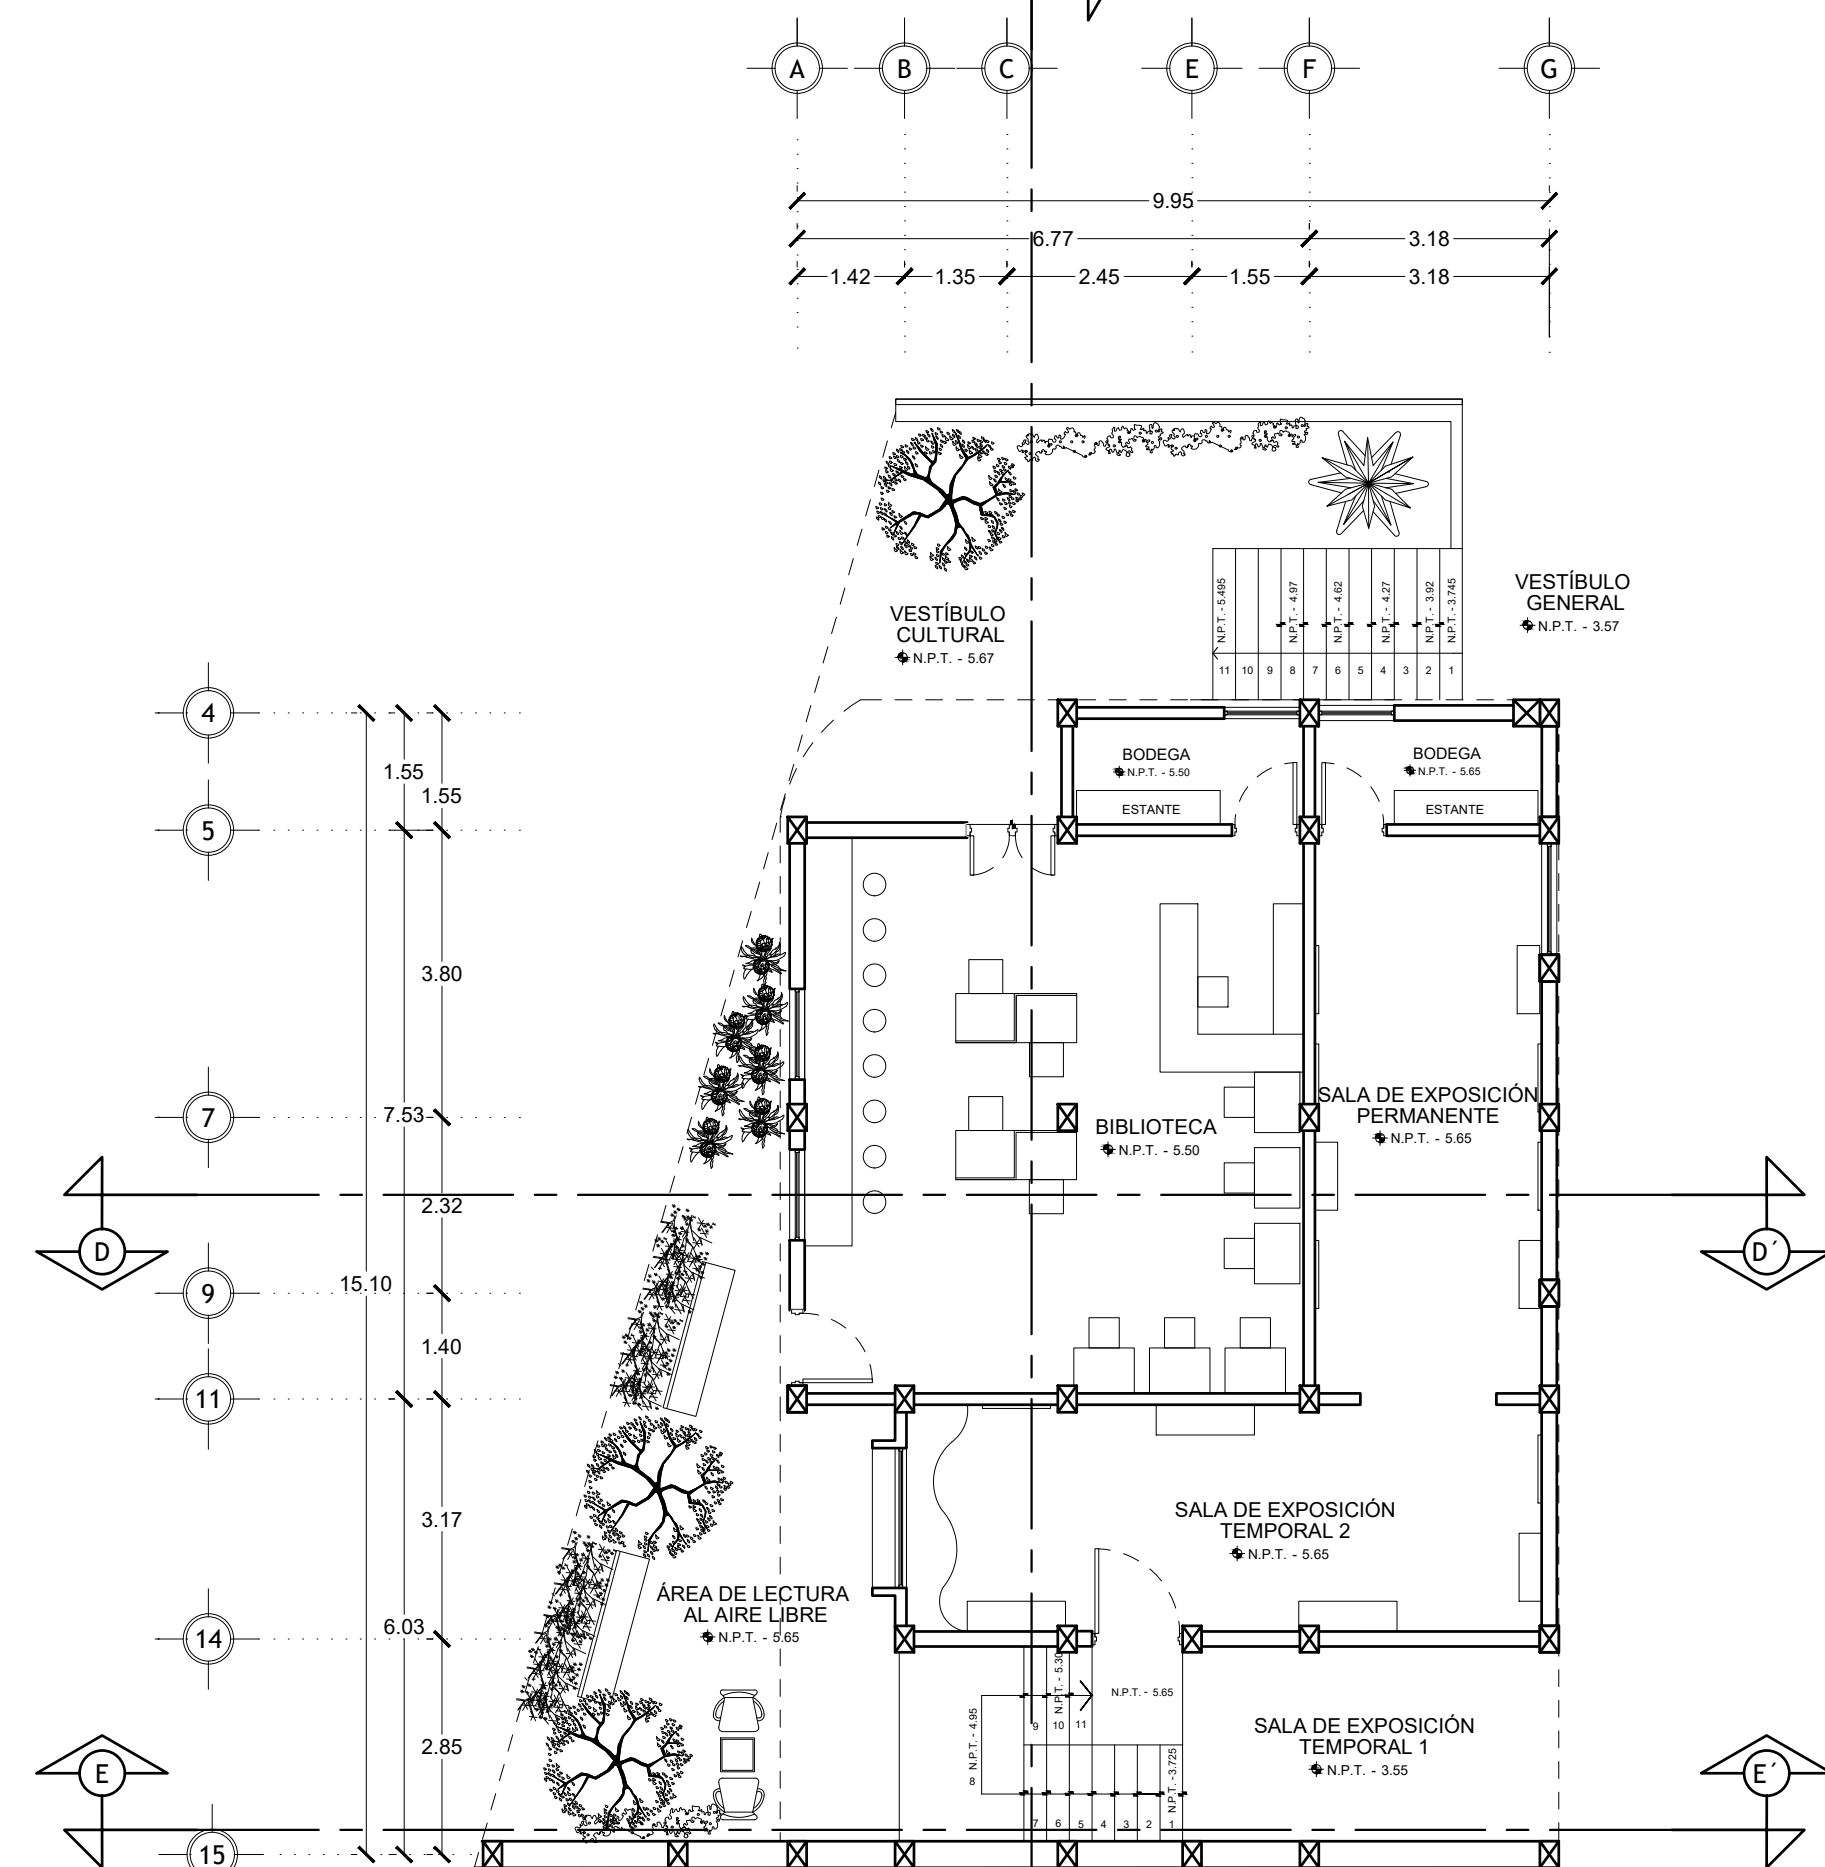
Distribución de la zona recreativa y áreas verdes en la planta 00,-01,-02,-03,-04. Fuente: Elaboración propia, 2021.
